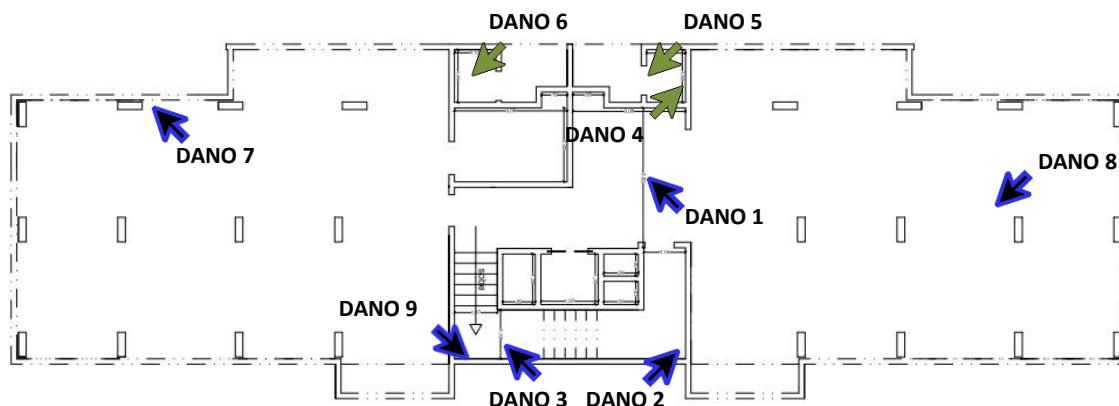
Planta Baixa (croqui) do pavimento térreo – Bloco A – Cond. Armando Lôbo.
